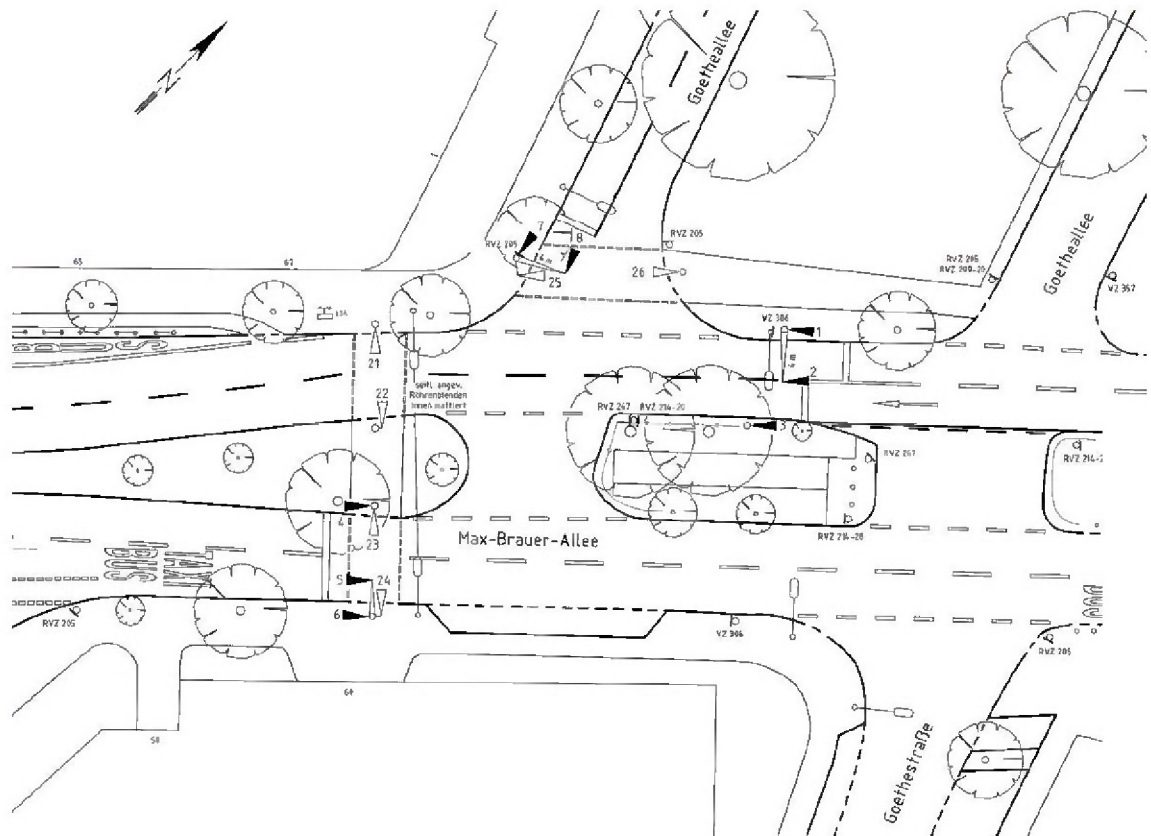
Signallageplan Max-Brauer-Allee/Goetheallee – Bestand (92/1771-04-01/03)
